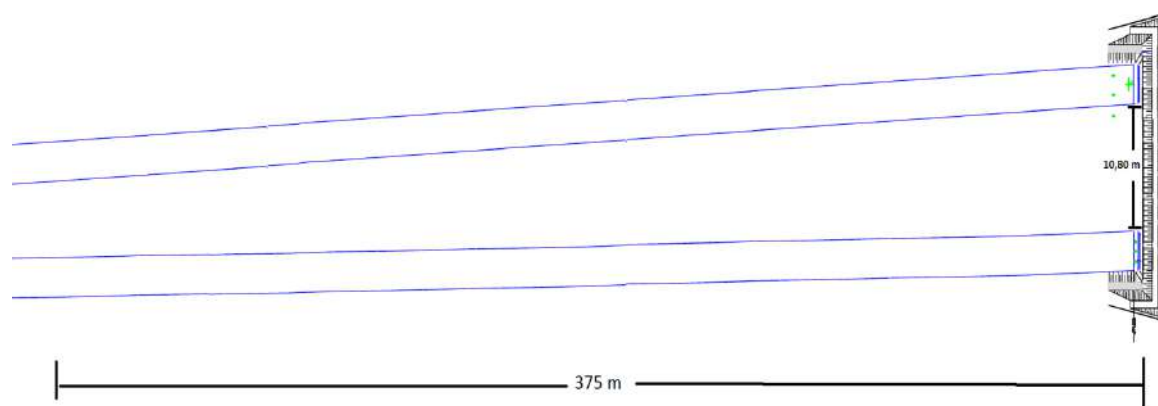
Proposition d'un tracé a l'entrée du tunnel
